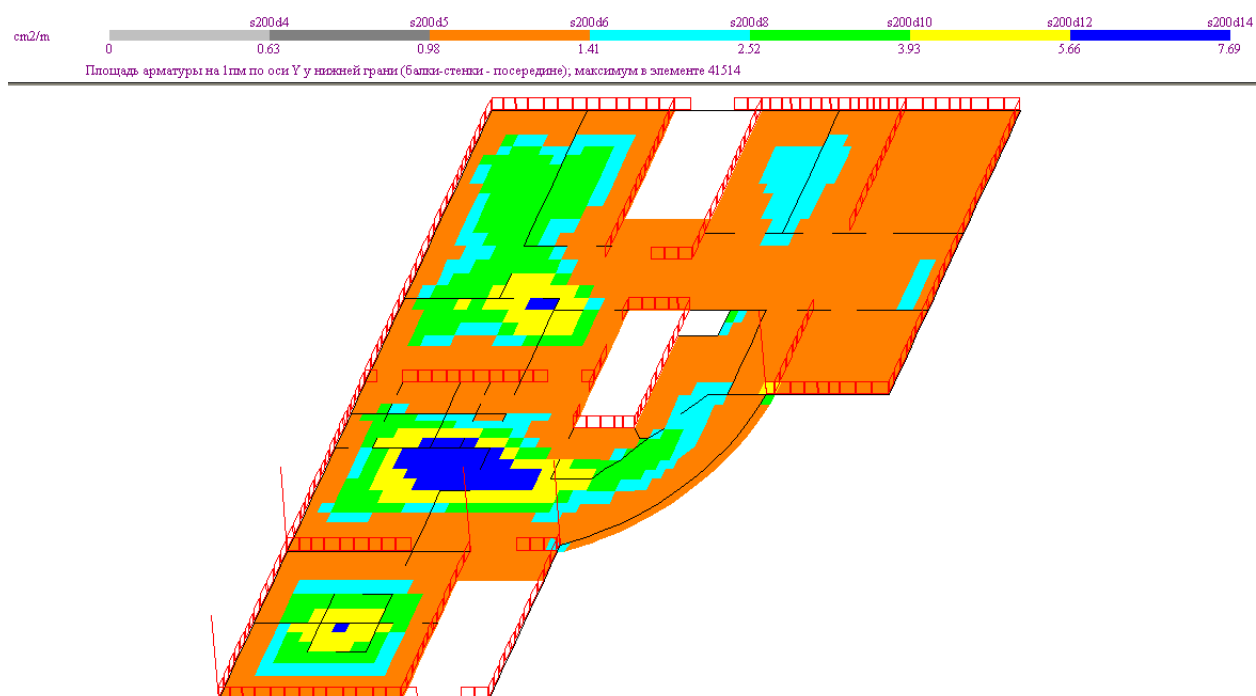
Требуемое армирование вдоль оси Y (нижняя грань)
